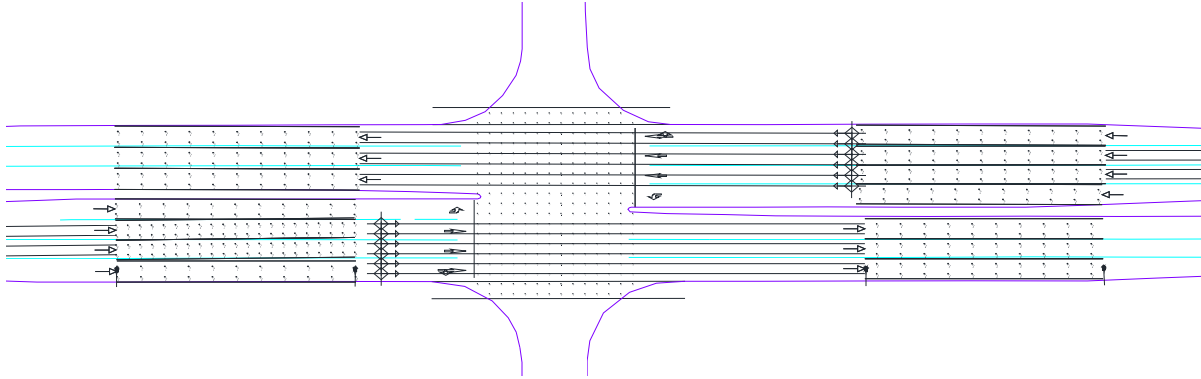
Grille de calcul pour l'éclairage des approches d'un carrefour plan
